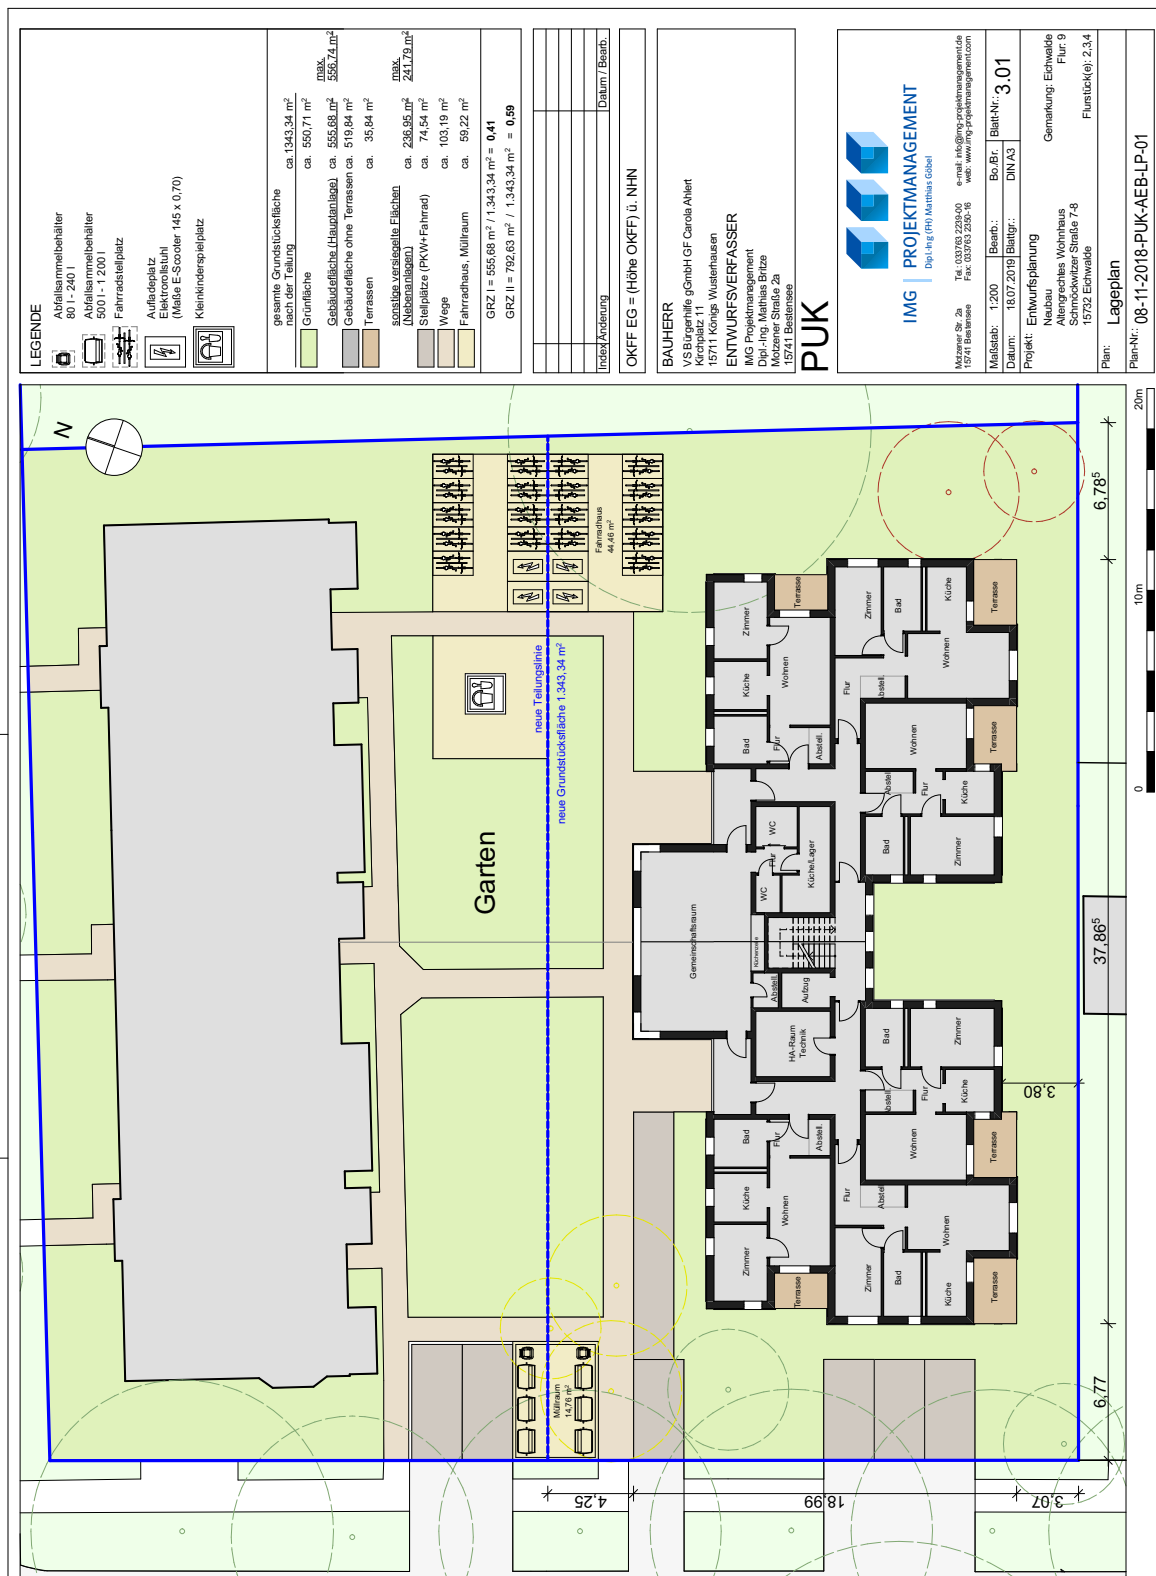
Lageplan altersgerechtes Wohnen. Variante: aufgelockerte Stadtvilla; Entwurf vom April 2019 (IMG Projektmanagement)
